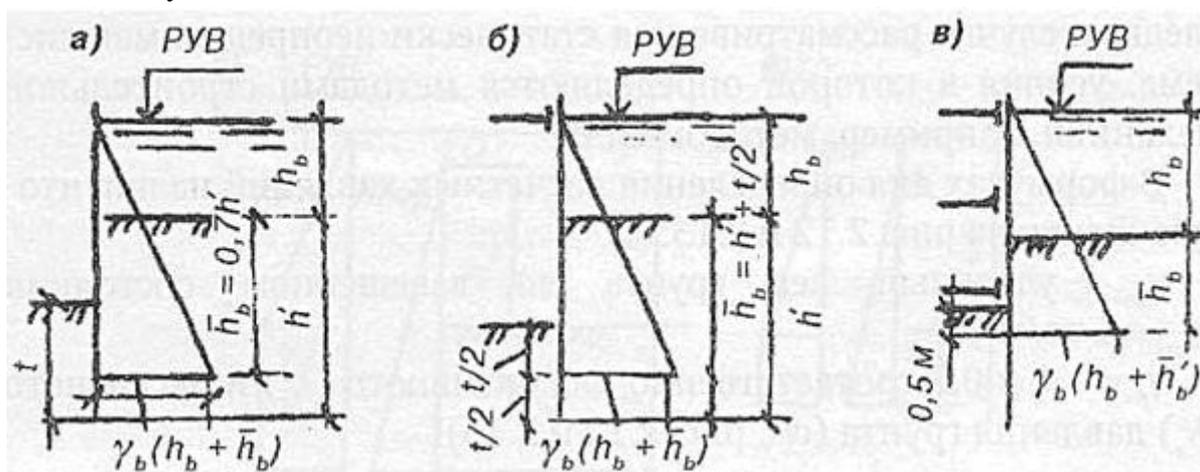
Схемы к расчету шпунтовых стенок, погруженных в связные грунты: а – при ограждении без распорок; б – с одним ярусом креплений; в – с несколькими ярусами
